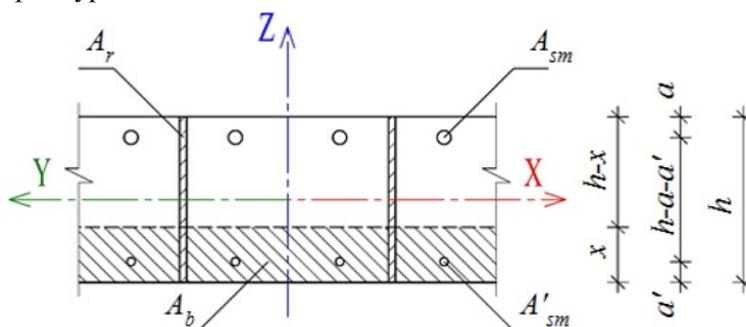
Нормальные сечения опорной зоны безбалочного перекрытия
